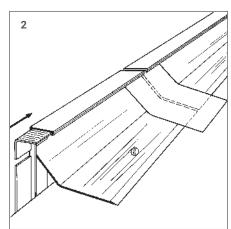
Stoßverbindung einschieben und Stoßfugen von ca. 6 mm vorsehen. Blendenprofile zwischen die Ecken fluchtgerecht montieren. Bei Unebenheiten Profil unterlegen. Profilstöße und Gehrungen der Ecken mit Abdeckbändern oder Bahnstreifen abkleben
